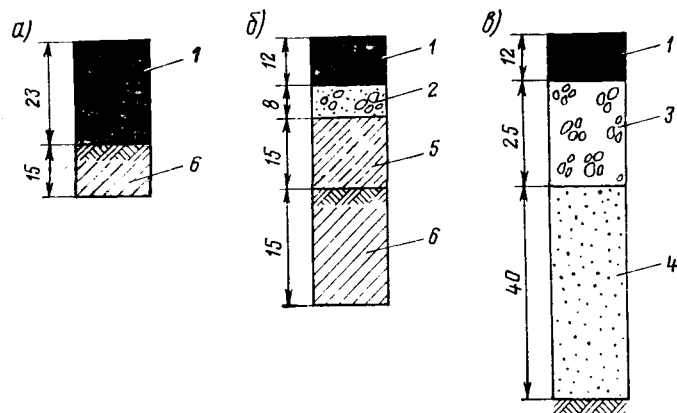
Примеры конструкций дорожных одежд на земляном полотне с укрепленным (а, б) и неукрепленным (в) верхним слоем:
